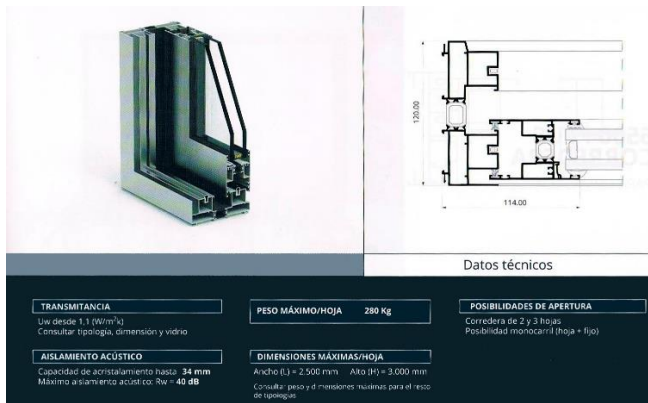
Sistemas de aluminio y PVC para la arquitectura. 2016. Cortizo.
